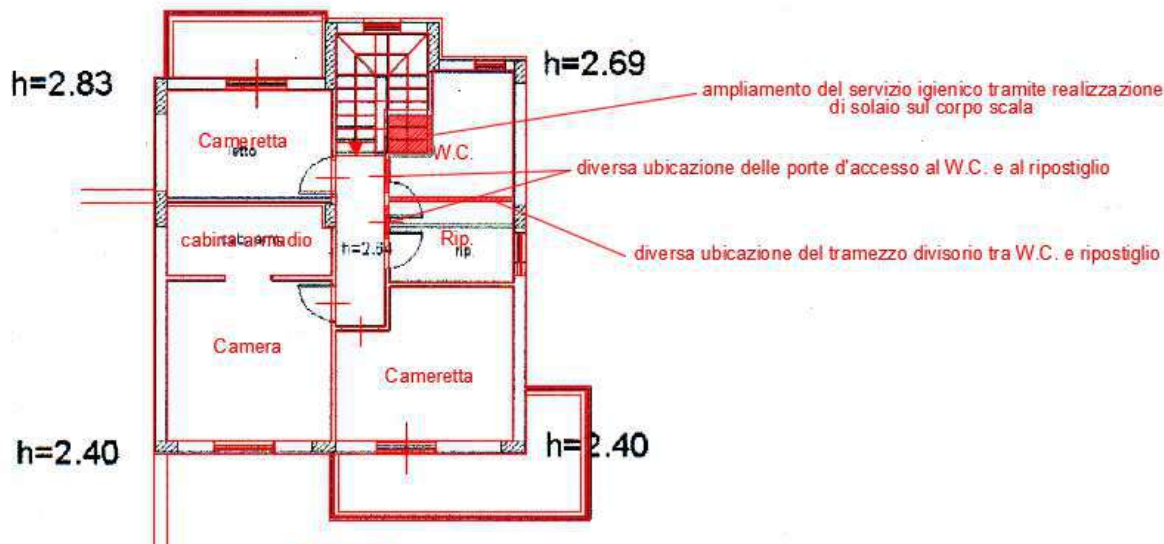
Sovrapposizione delle planimetrie di rilievo con la planimetria catastale relativa al piano primo
